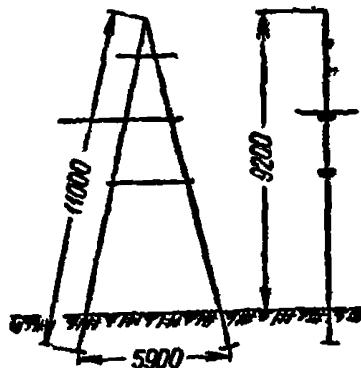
Угловая промежуточная опора на угол 45° с конструкцией под разъединитель
